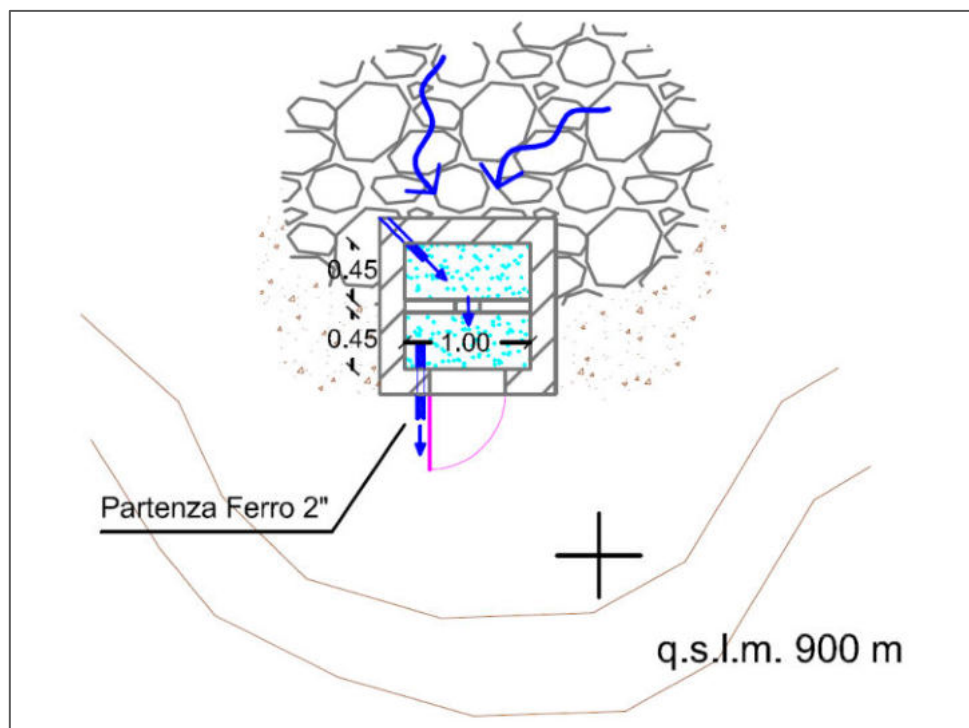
Pianta Sorgente 1 e 2 Le Polle
